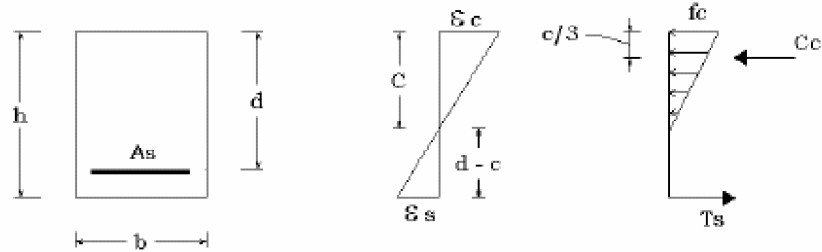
Sección transversal de una viga simplemente reforzada, diagramas de deformaciones y esfuerzos
